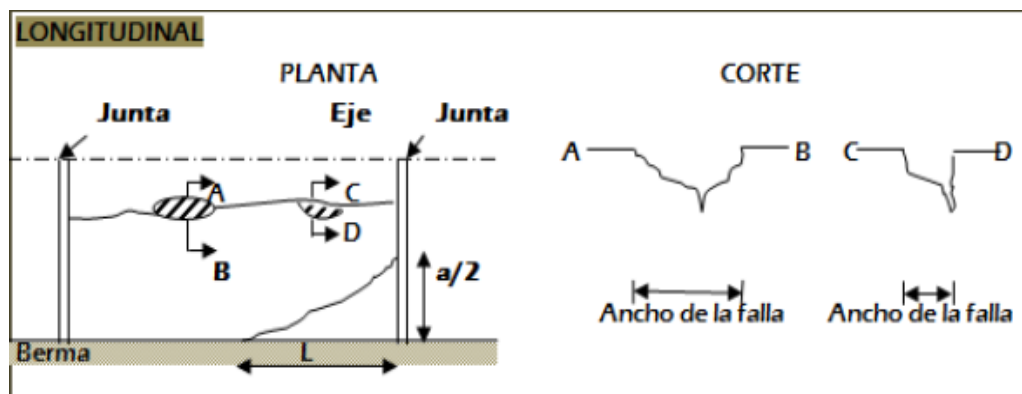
Esquema de la vista en planta y corte de una grieta longitudinal en una losa de concreto.
